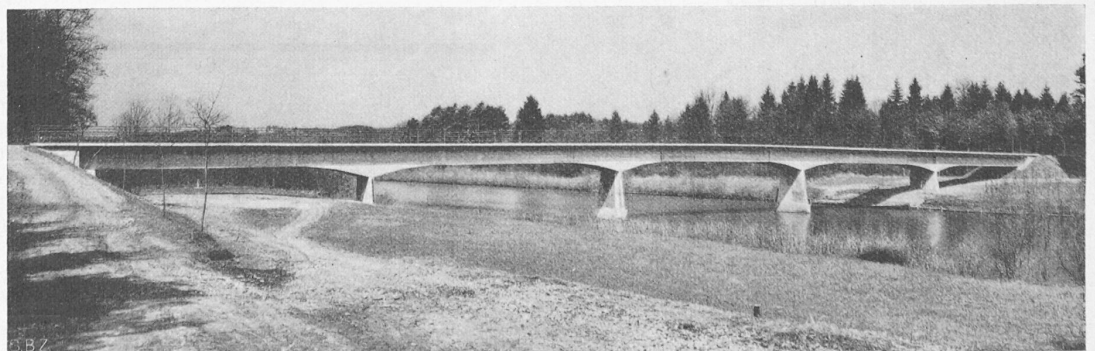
Plattenbalken-Strassenbrücke über fünf Oeffnungen, grösste Spannweite 24 m
